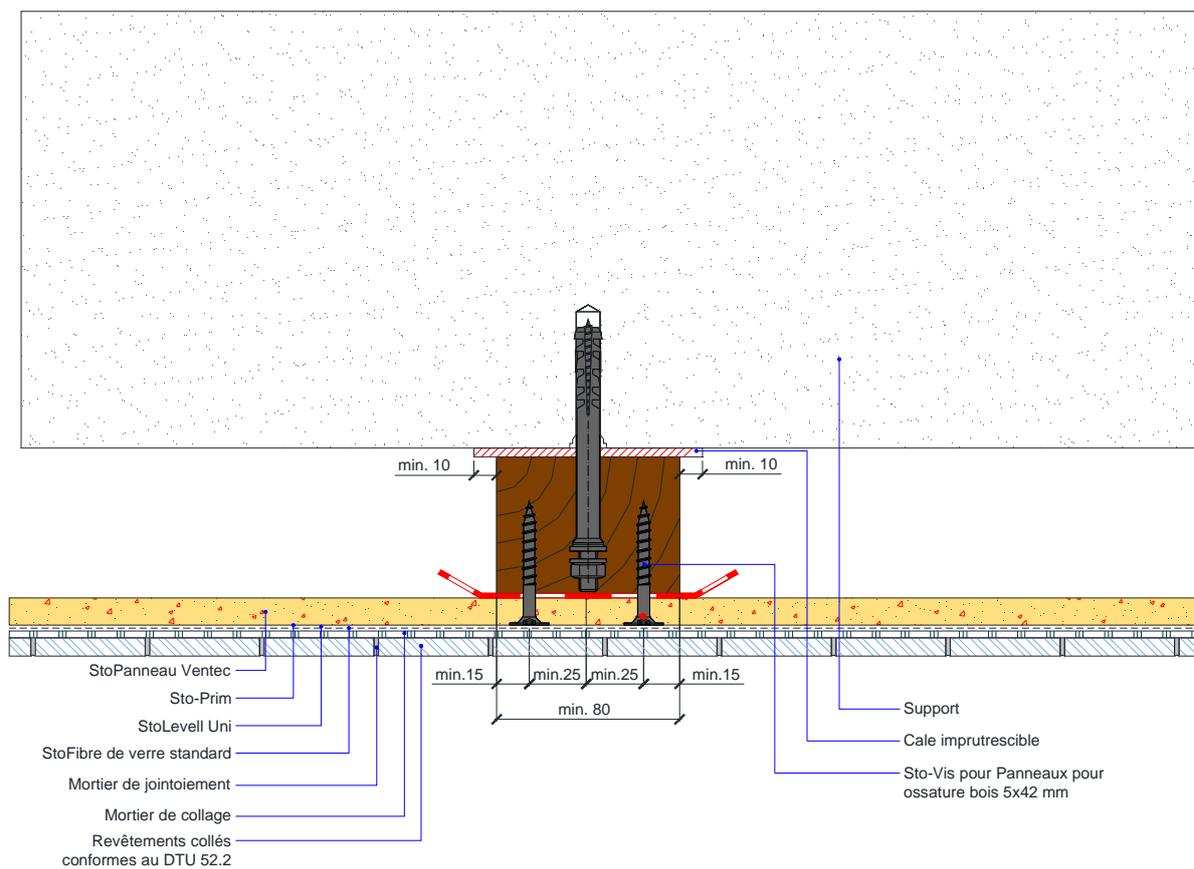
Fixation directe sur le support – Ossature bois – Coupe horizontale
